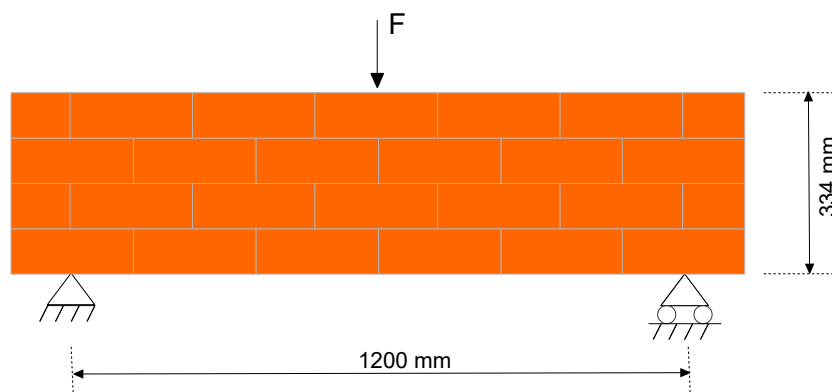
Viga de alvenaria: geometria, condições de contorno e carregamento.
